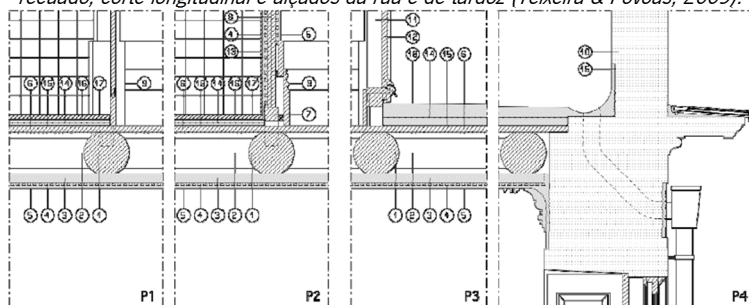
Modelo construtivo das casas burguesas do Porto – Pormenores tipo (Teixeira & Povoas, 2009).
